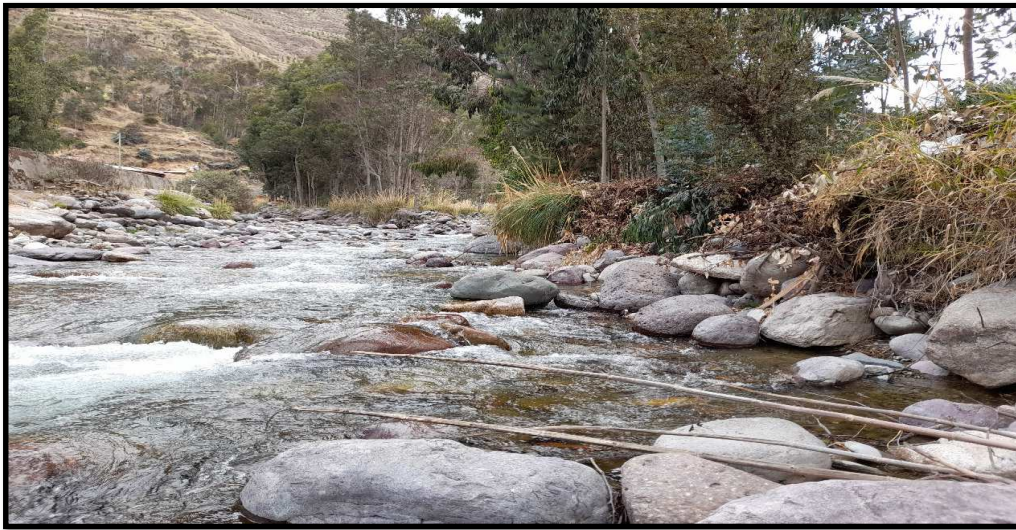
VISTA DEL PERFIL DEL SUELO DONDE SE CONSTRUIRÁ EL MURO
